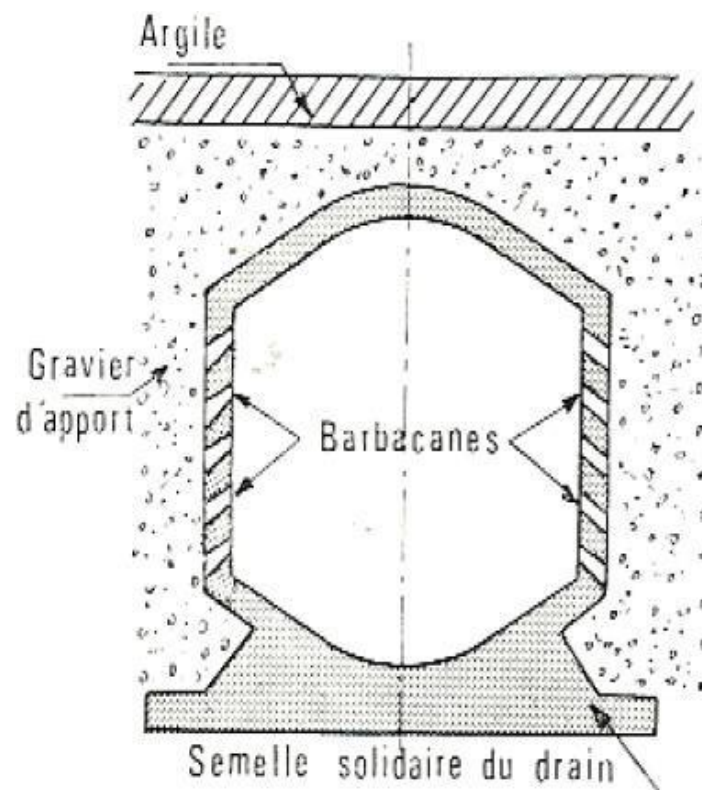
Coupe type d'un drain captant (Dupont, 1978)
